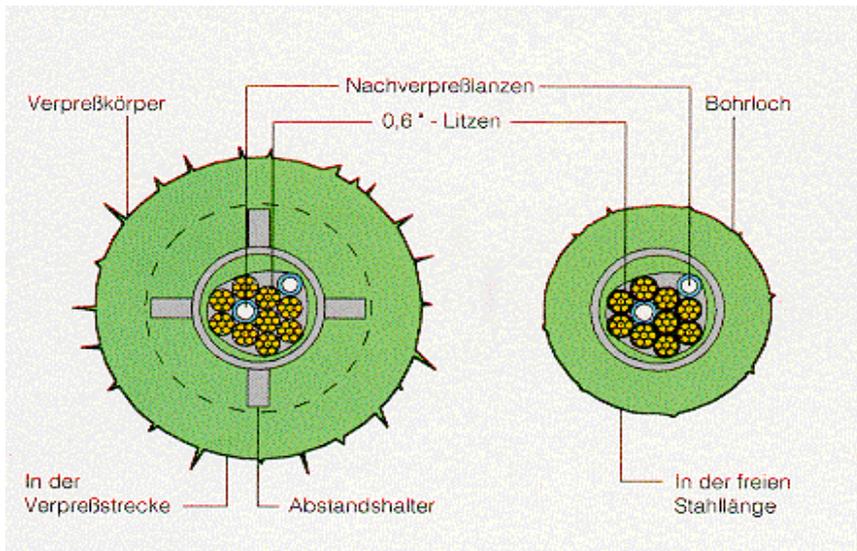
Schnitt durch einen temporären Litzenanker [2]
